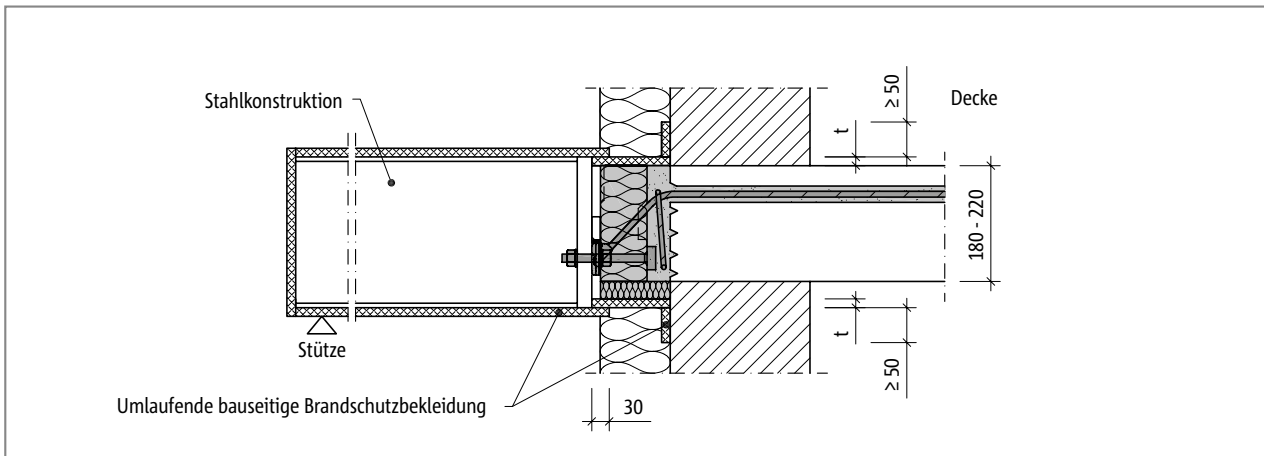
Schöck Isokorb® RT Typ SQP: Bauseitige Brandschutzbekleidung RT Typ SQP und Stahlkonstruktion; Schnitt
